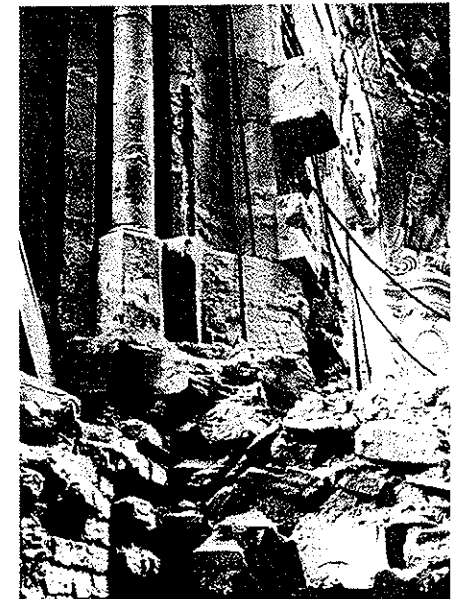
Fußausbildung des Nordwandpfeilers W 1/2, Erdgeschoß
